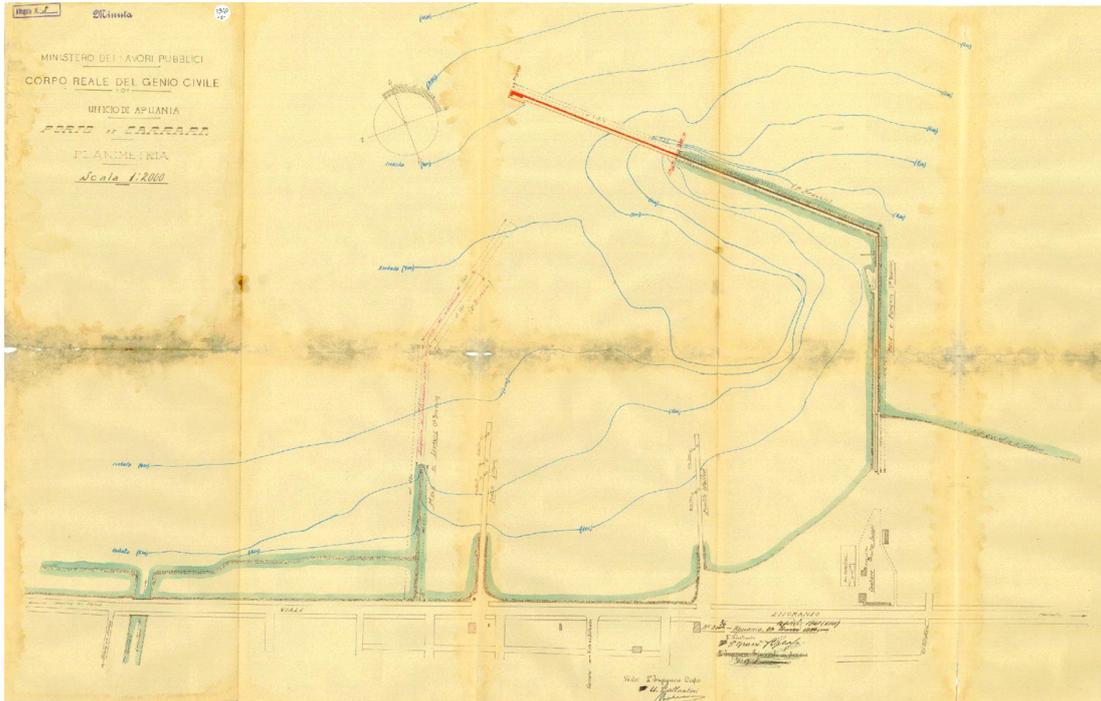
Planimetria di progetto delle opere foranee del 1940 (fonte: Archivio OO.MM.)
